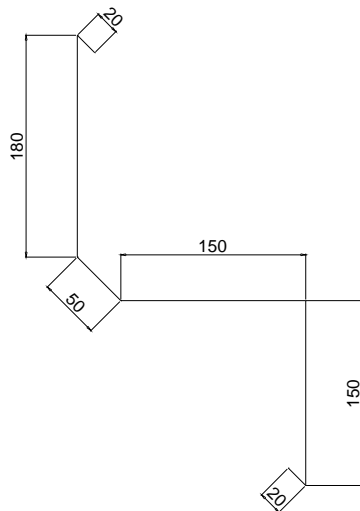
Relevé en tête sur mur en héberge (épaisseur 1 mm)
